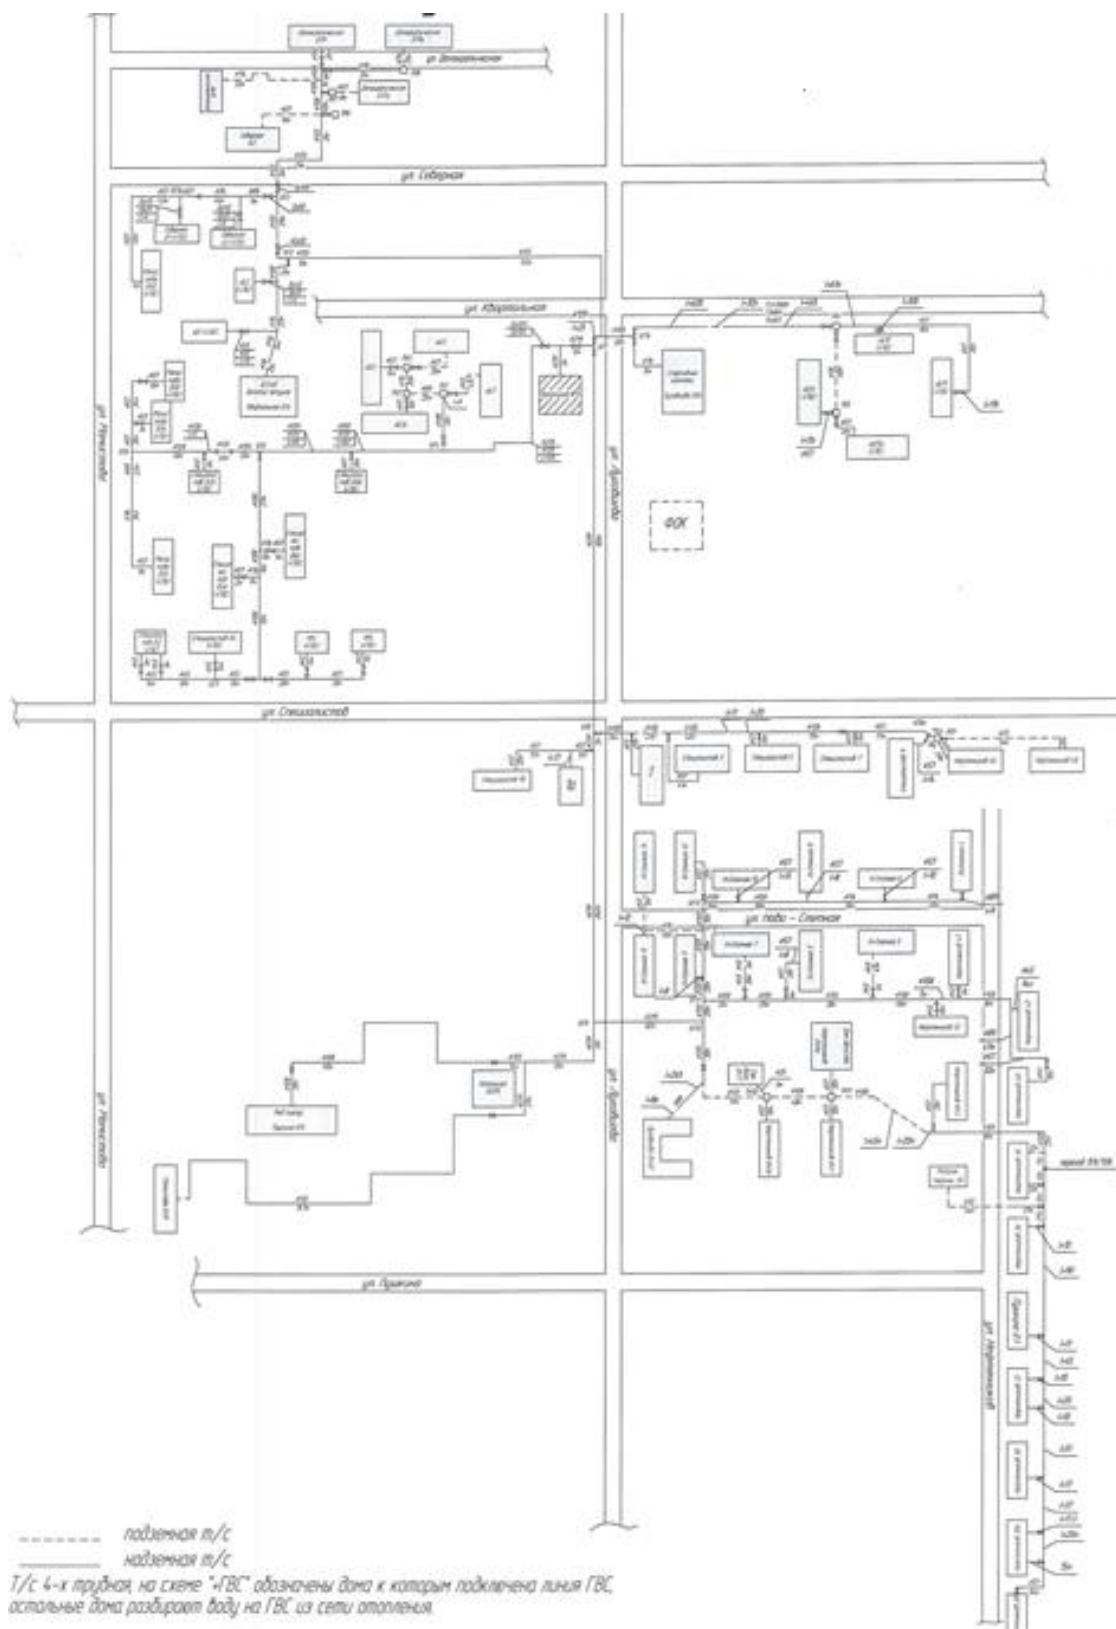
Схема тепловых сетей от здания котельной №3 п. г. т. Безенчук
